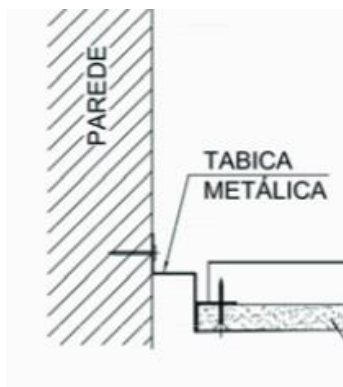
Detalhe do perfil tabica no perímetro do forro estruturado
